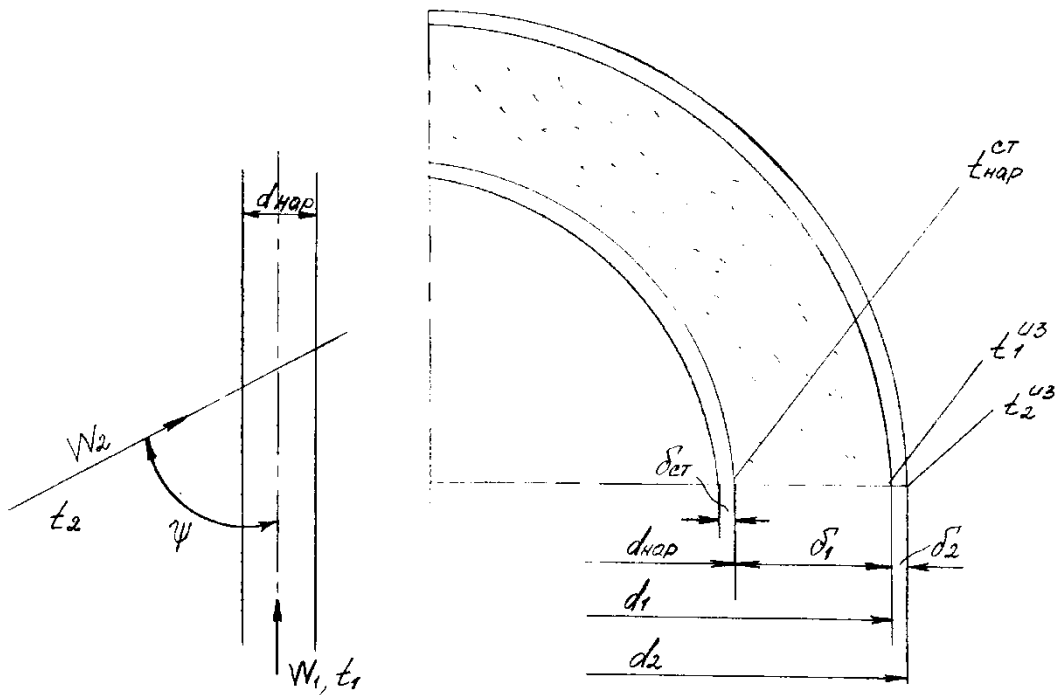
Эскиз расположения трубопровода и тепловой изоляции на трубе
